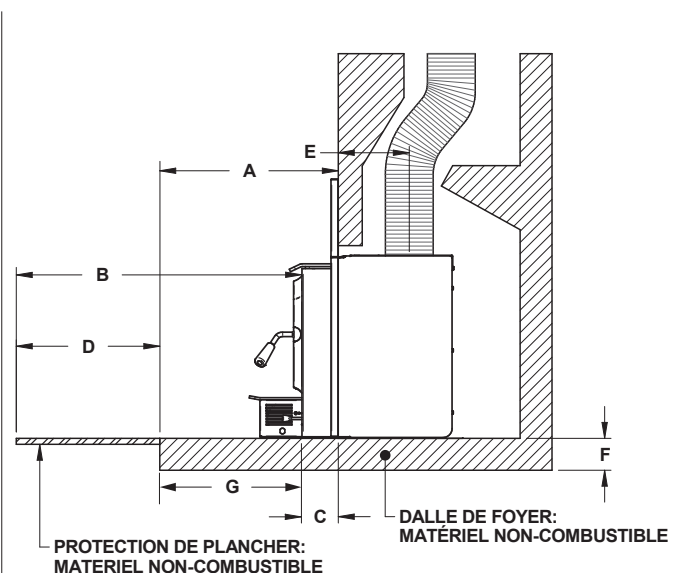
Protection de plancher aditionnelle - Installation non surélevée
